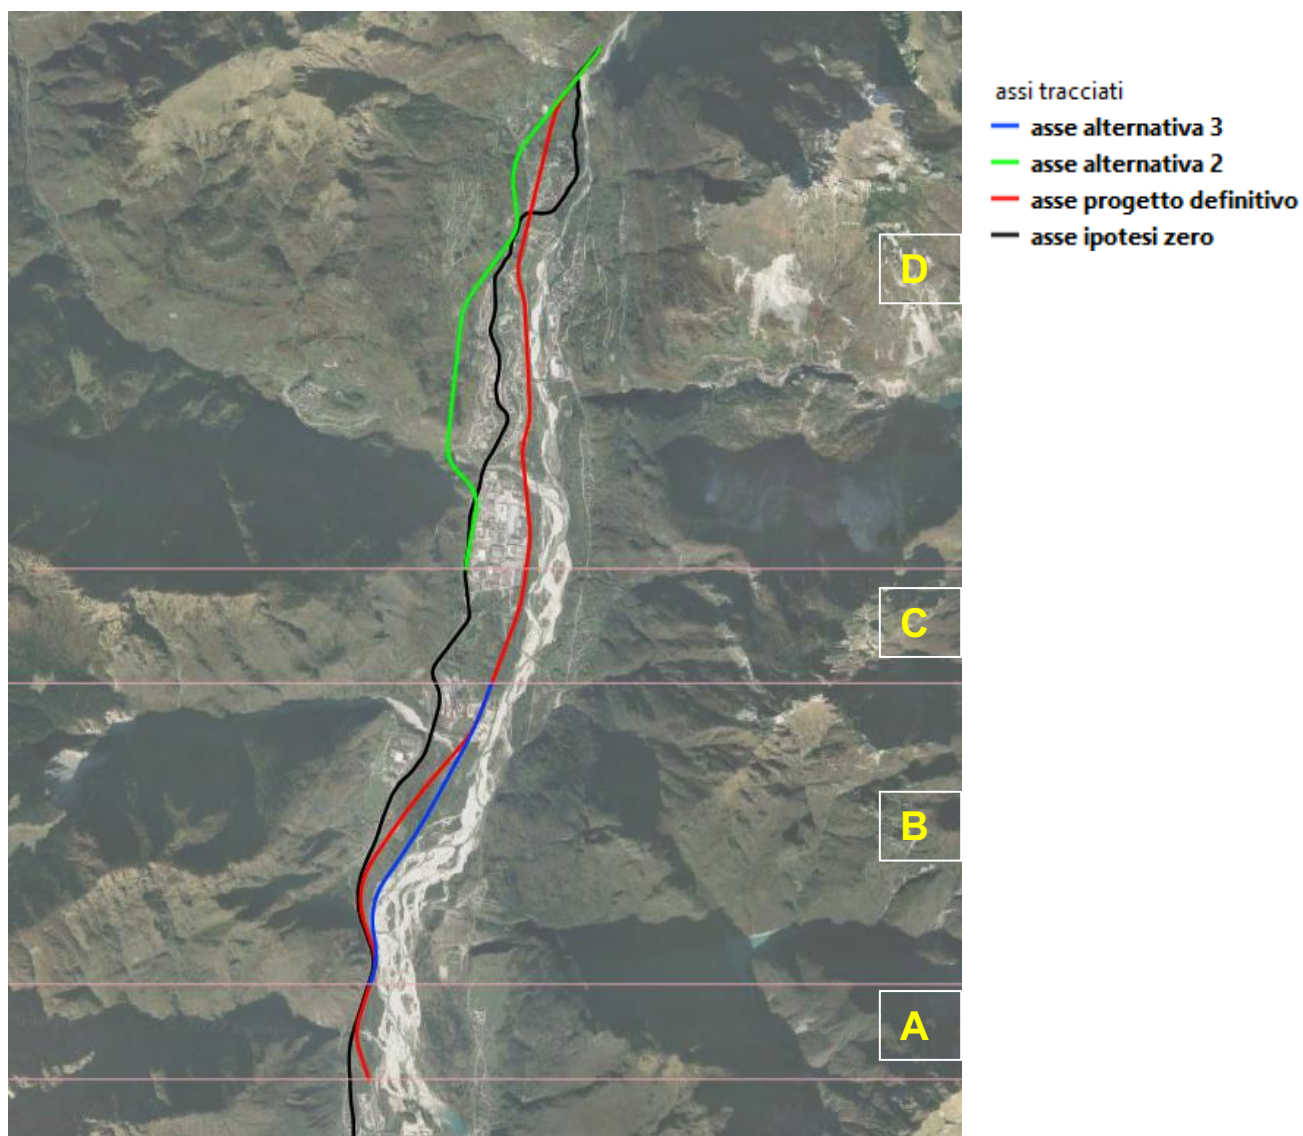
Localizzazione delle alternative di tracciato su ortofoto e individuazione dei tratti esaminati
